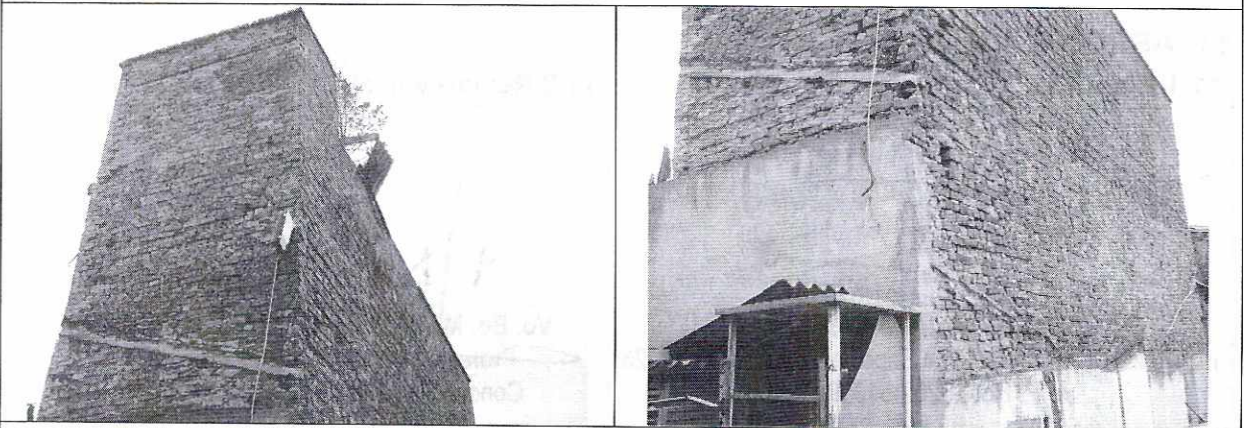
y 6. Vista costado sur oriental del predio. No se observa daño en muros
